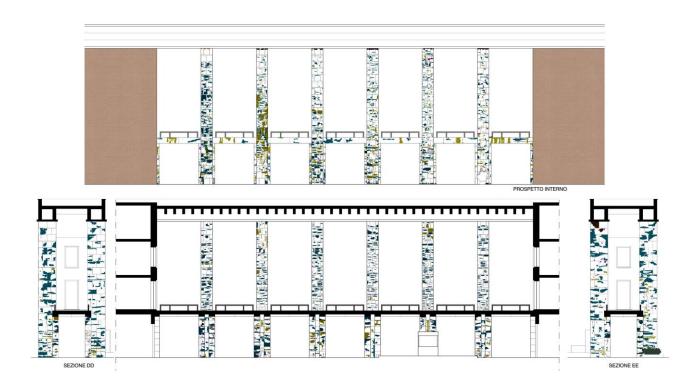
Prospetto e Sezione dei Propilei (mappatura Arch. S. Massimilla)
